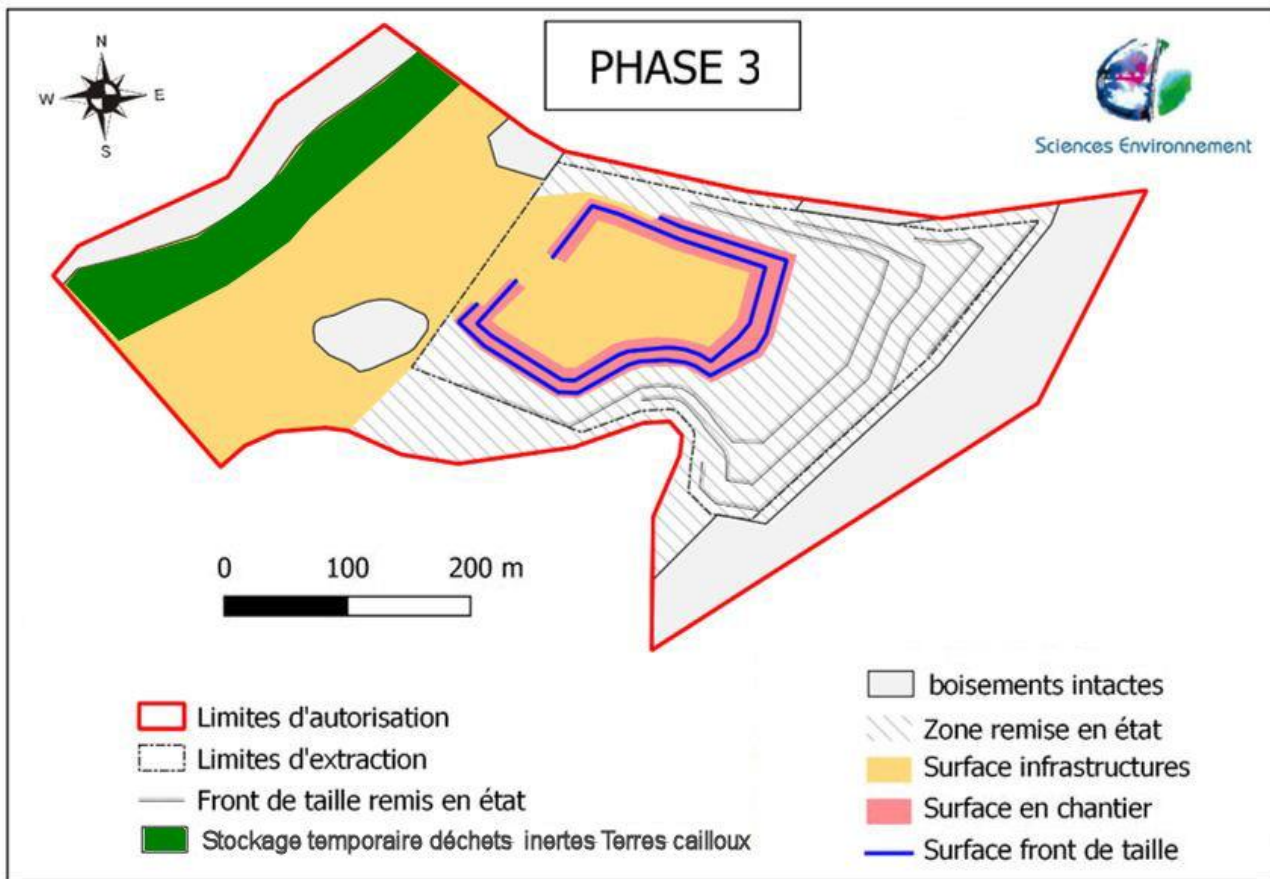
Plan de localisation du stockage temporaire de terres et cailloux inertes
